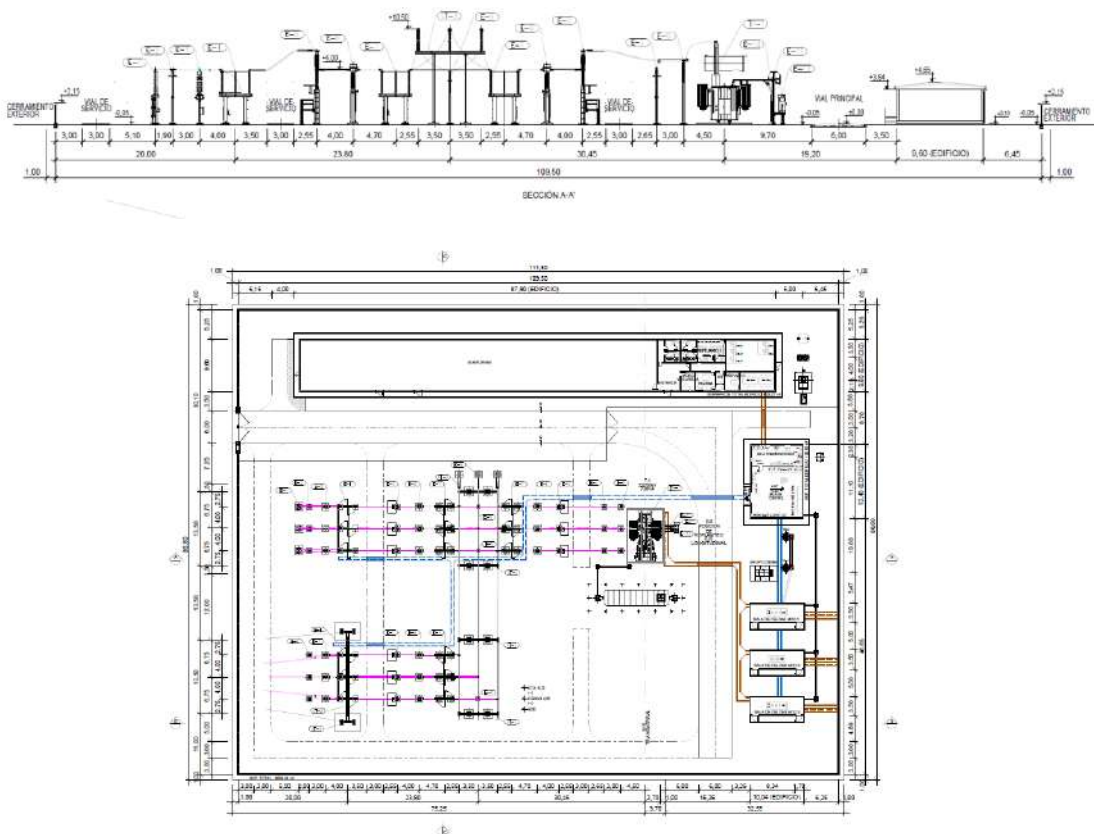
Planta i secció de la nova SET La Femosa.
